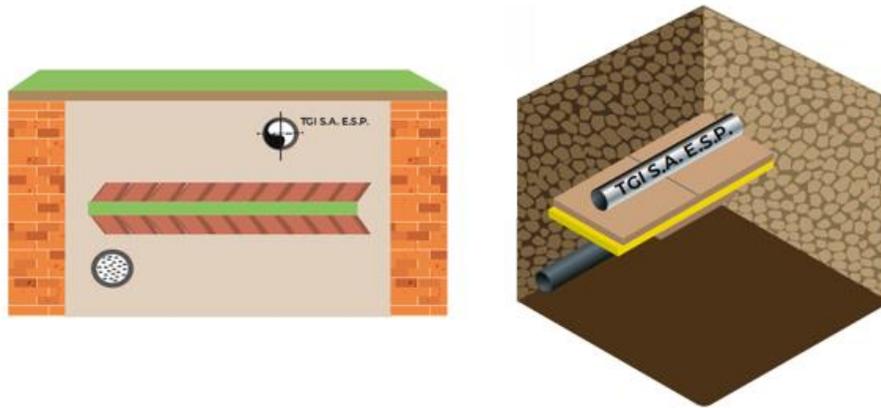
Protección con baldosas, losetas o placas de cemento más planchas de caucho sintético o placas de PRFV-parallelismo.
